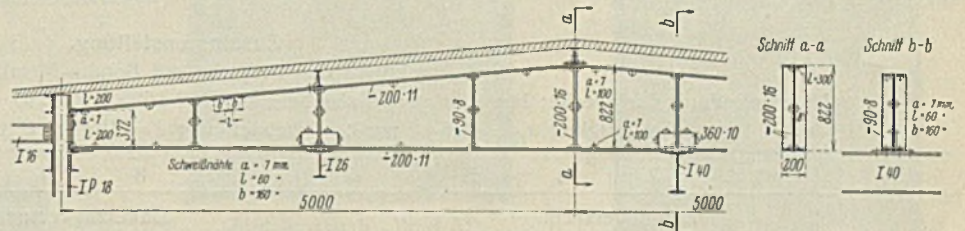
Geschweißte Dachbinder der Röstofenhalle.
